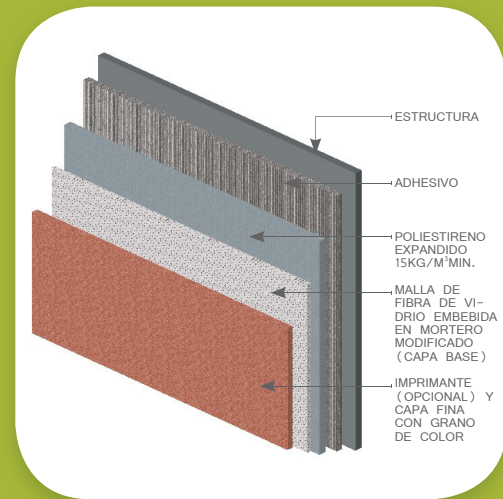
i: Componentes del sistema de barrera, en estructura pesada (albañilería u hormigón), vista isométrica.
